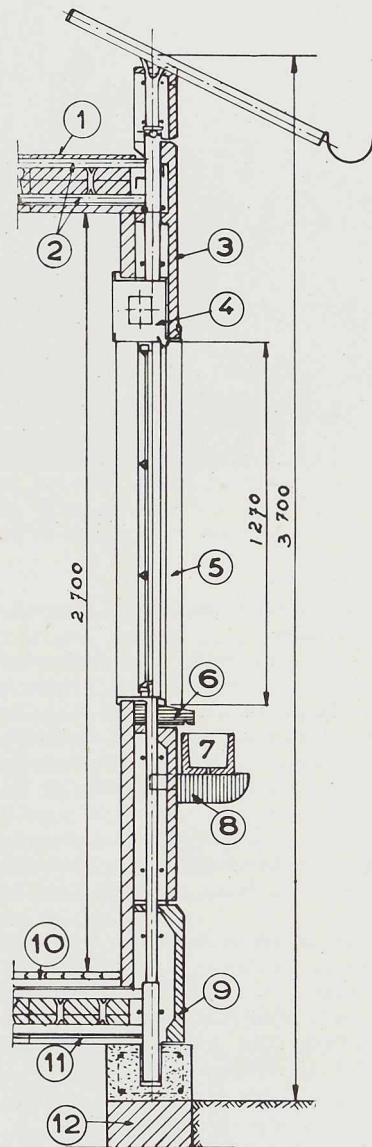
Coupe transversale à travers le mur, au droit d'une fenêtre :
